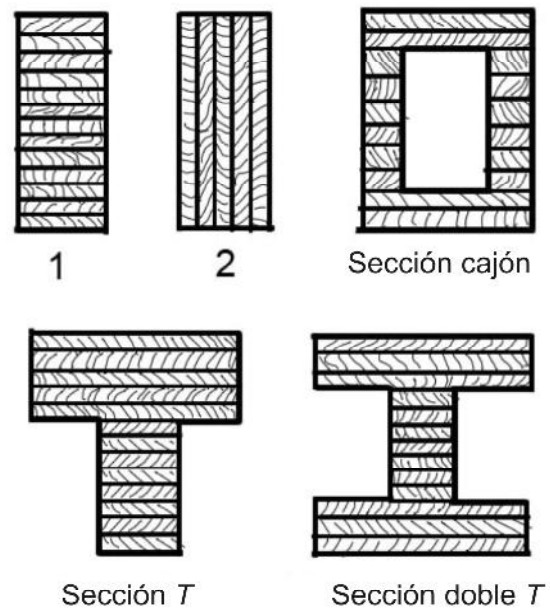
Secciones más usadas en las vigas de madera laminada encolada.
